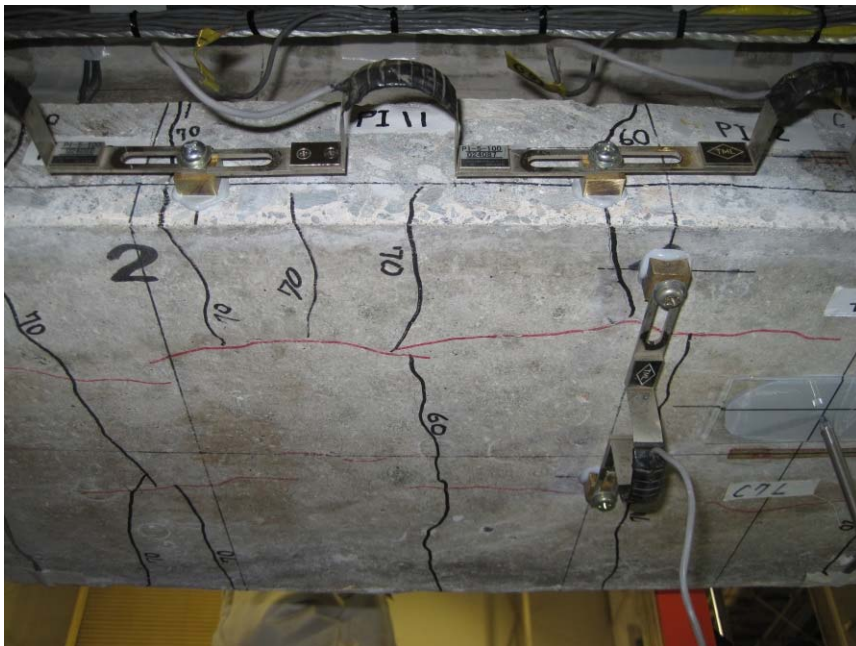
70kN 載荷時 G6 桁下面ひび割れ状況 (4'位置： PI-19)
